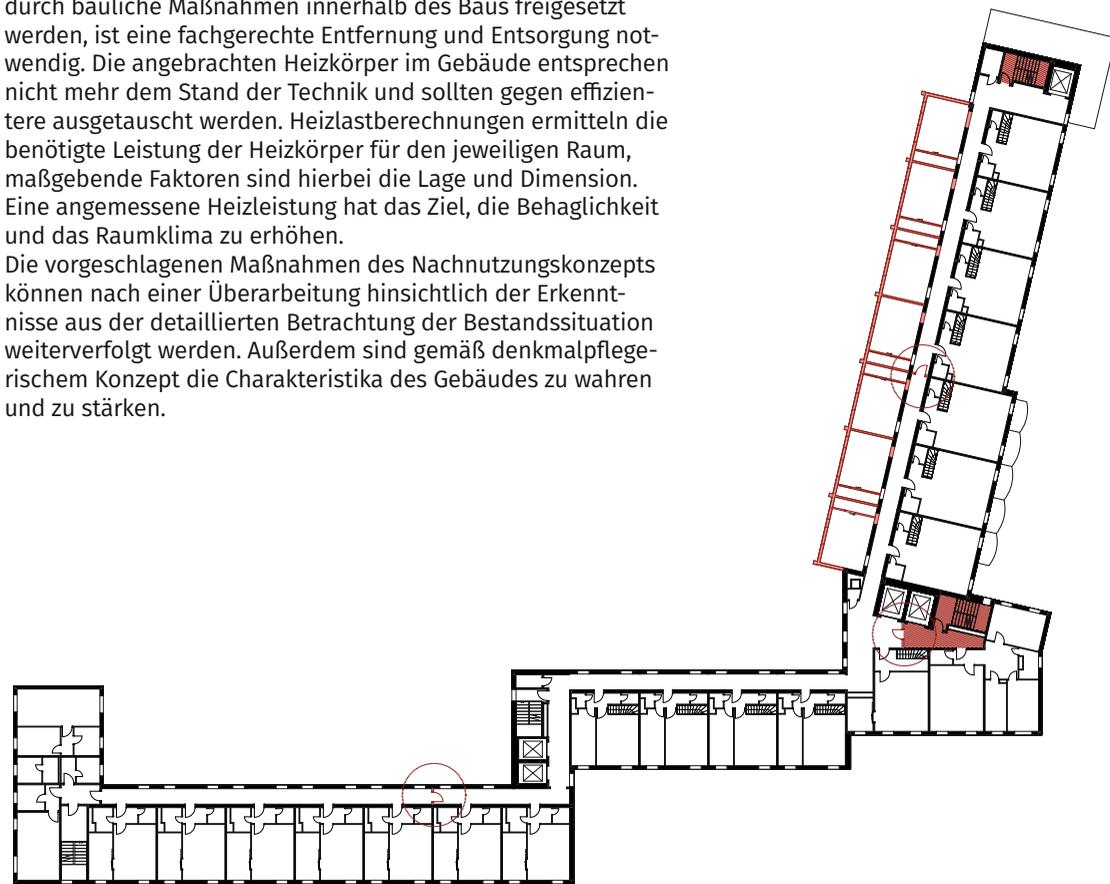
Grundriss. Brandschutzmaßnahmen
